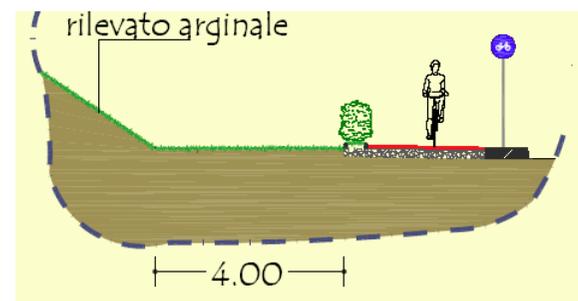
Piste ciclabili – Distanza minima da rilevato arginale
